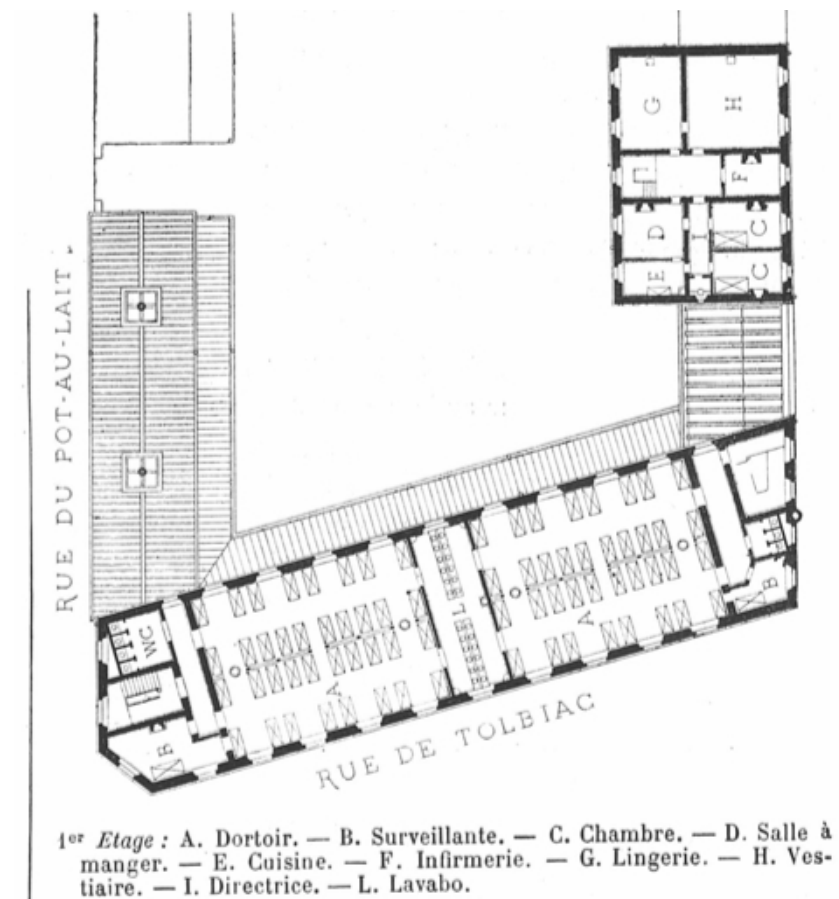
Asile Michelet*. Planta do primeiro pavimento.. (Fonte: La Construction Moderne, Asile, 1896)
